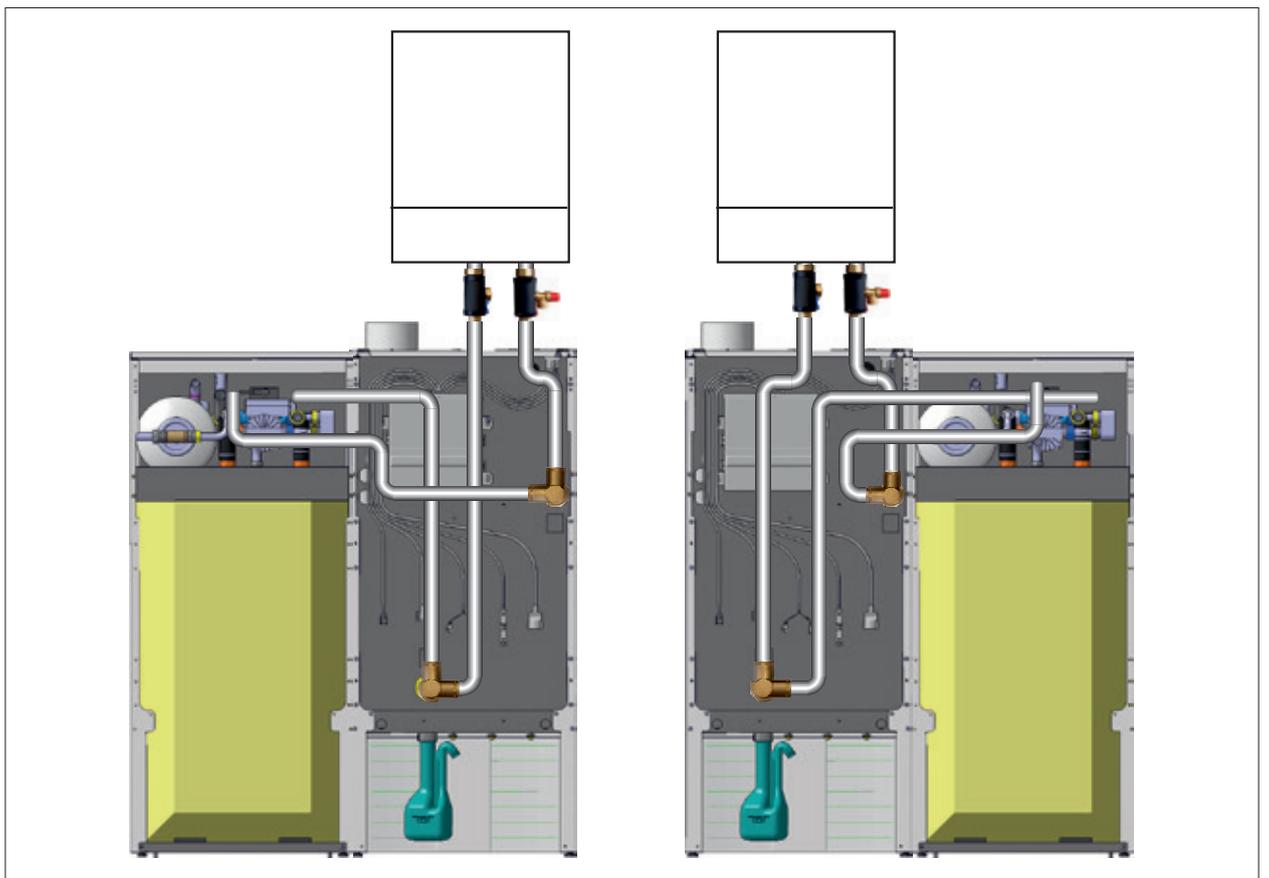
Kit di collegamento dietro alla caldaia sulla parete
